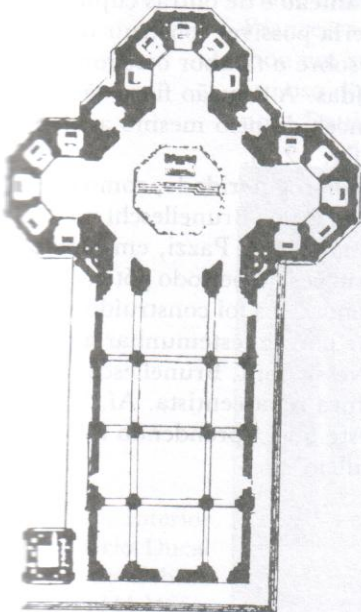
Planta da catedral de Santa Maria del Fiore, Florença.
